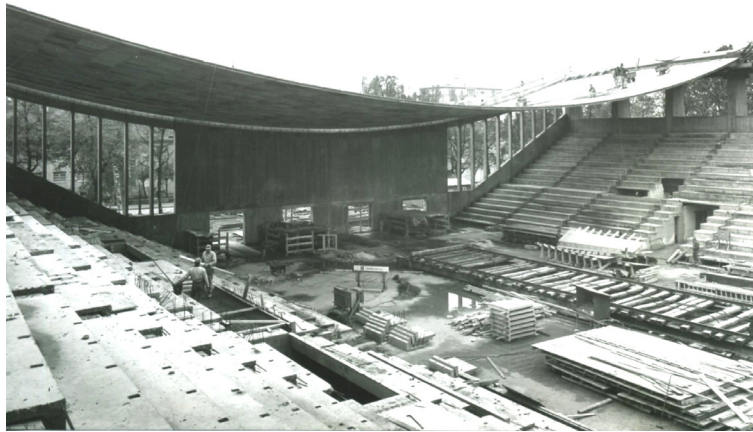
Sporthalle Augsburg, Ansicht des teilweise montierten Dachs, Architekt: Hugo Gall (BNr. 37) [Bild-Archiv des Instituts für Tragwerksplanung, TU Braunschweig]
